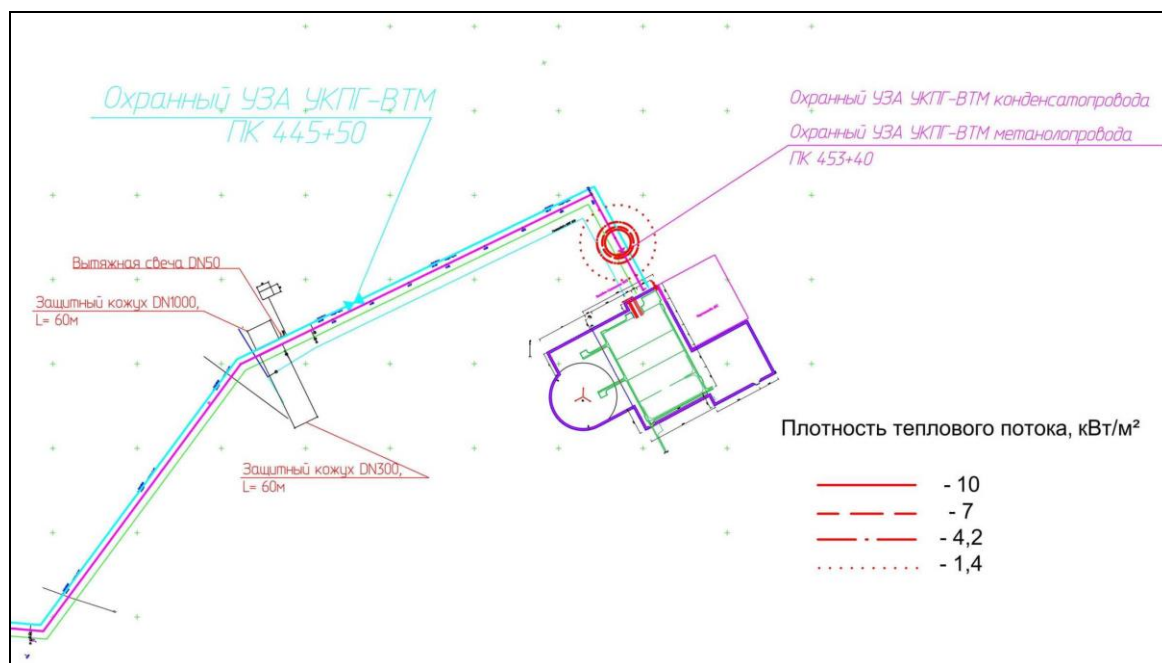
План наиболее вероятной аварии на газопроводе в районе ЗСМ
